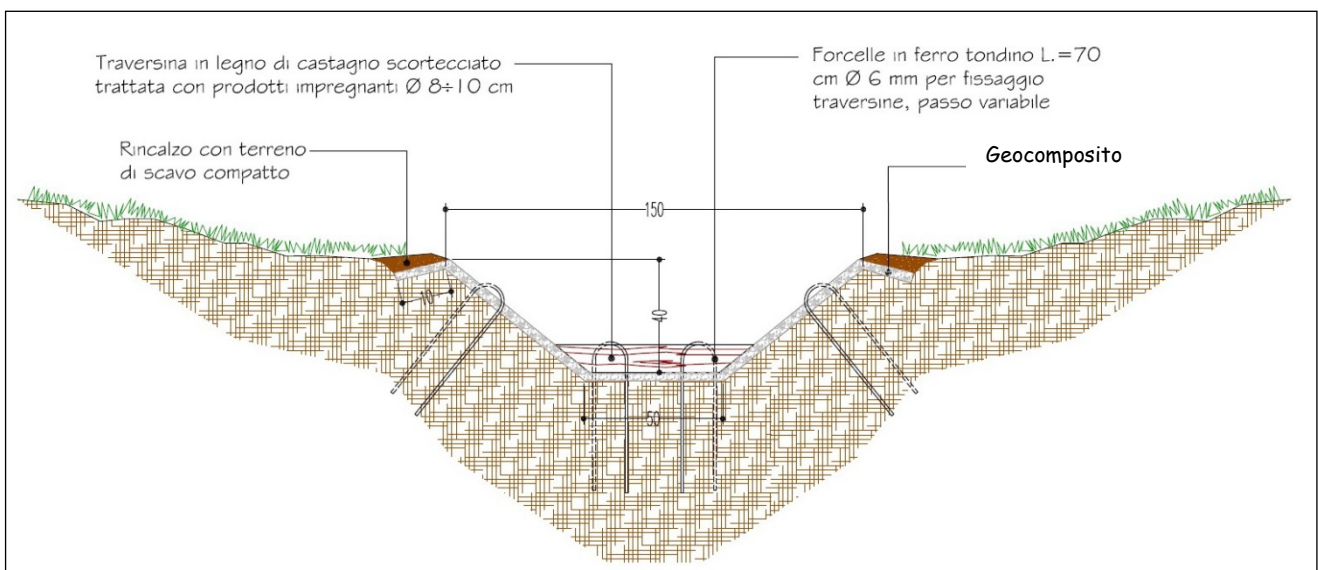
sezione trasversale fosso impermeabilizzato con geocomposito tipo "Trenchmat"
